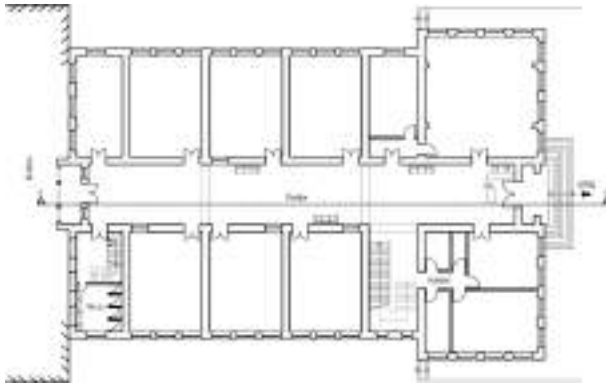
Dar-ül Muallimat Mektebi Plan Şeması
